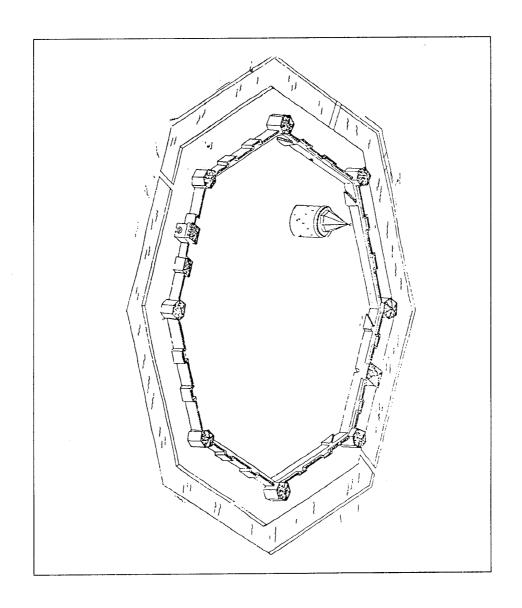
مسقط أفقي لقلعة بكين بألبانيا (عن : كيل) .
